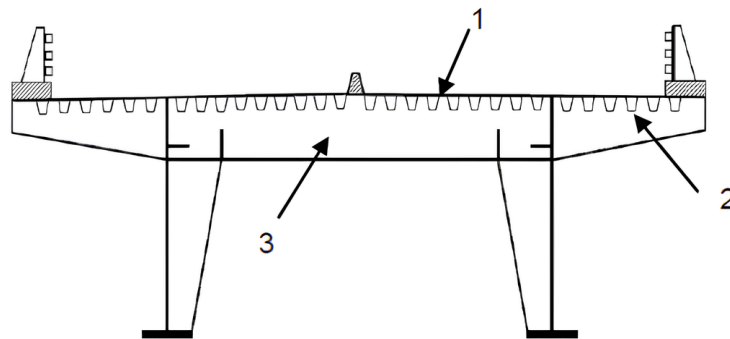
Coupe transversale d'un tablier à dalle orthotrope [4].
